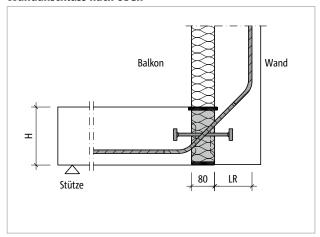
Schöck Isokorb® T Typ QP-WO: Wandanschluss nach oben bei Aussendämmung
